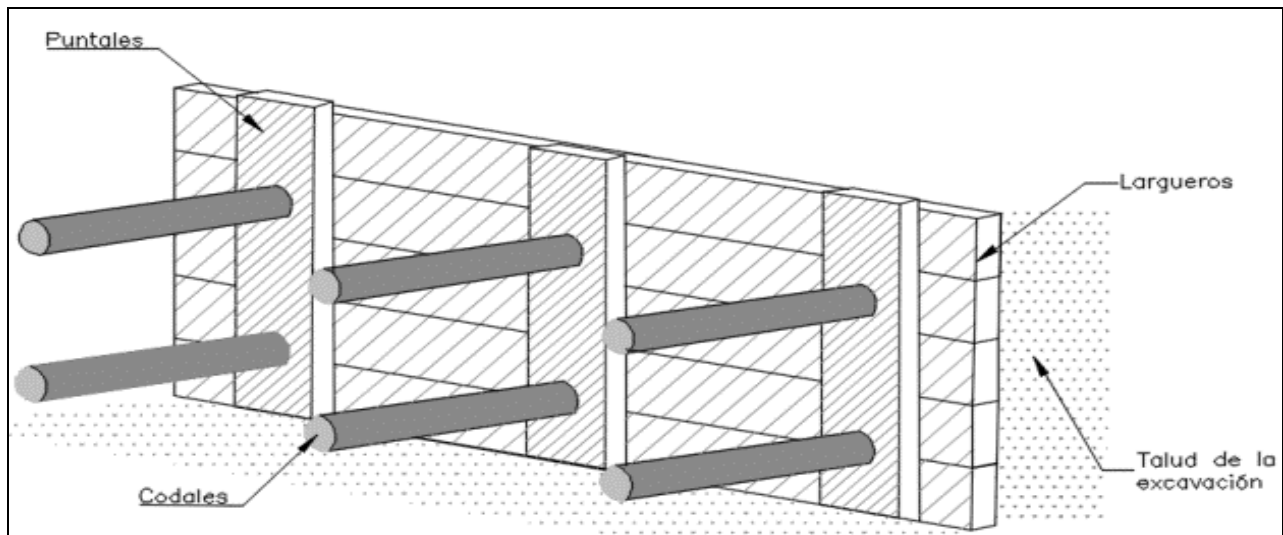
Detalle proceso de entibado en madera para soporte temporal en procesos de excavación para cimentaciones. Tomado de Norma De Construcción Estructuras Temporales De Contención-EPM.
